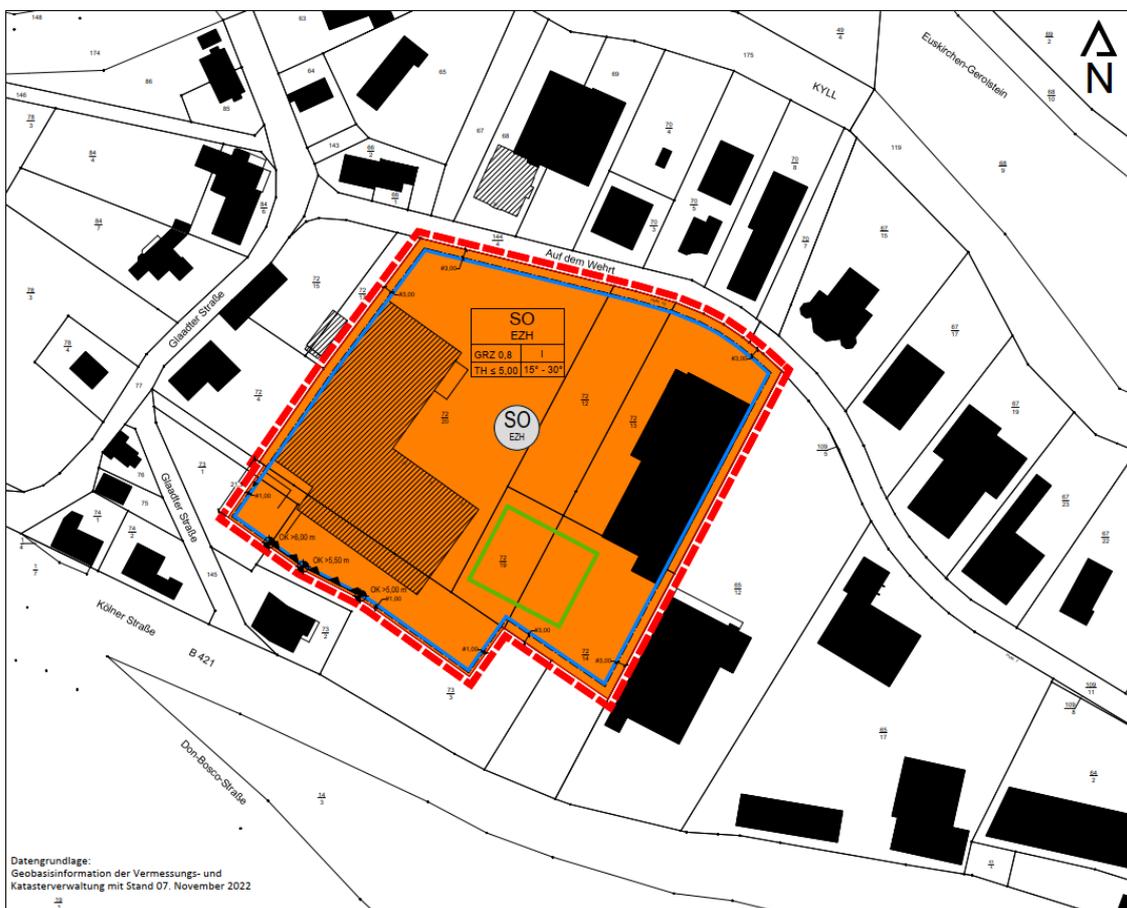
Planbereich, unmaßstäblich, genordet, Auszug aus städtebaulicher Planung
